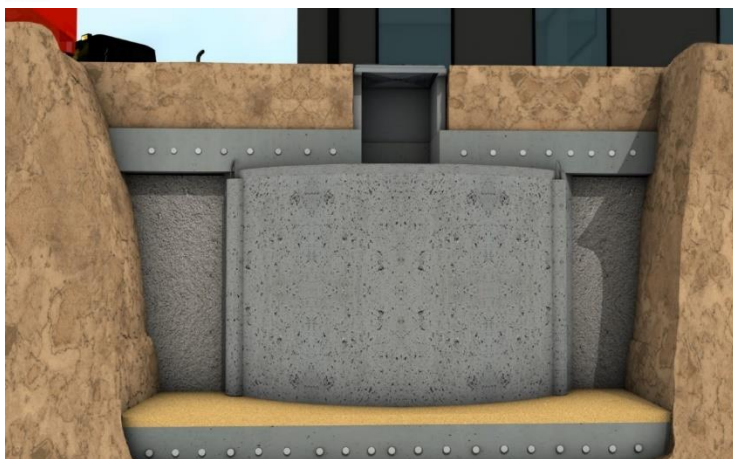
Dalle de fondation en béton armé avec couche de remplissage
